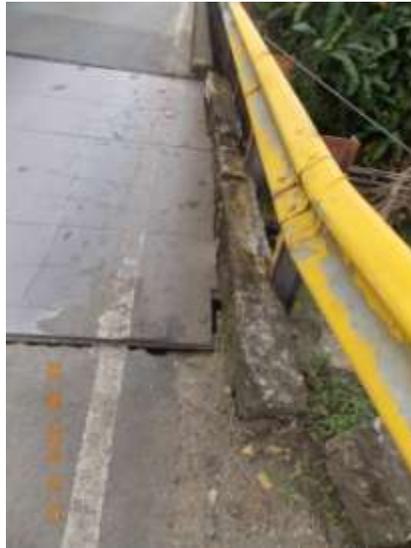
Puente sobre río Tuba. Guardavías anclado a elemento de concreto que está separado de la estructura.
